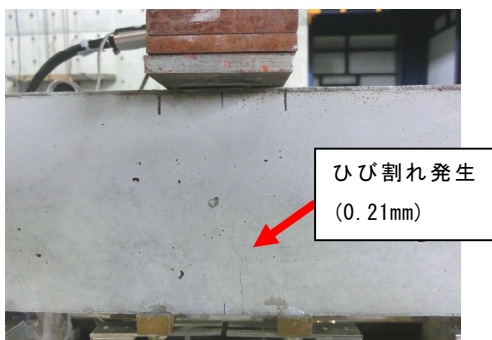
AZY2 ひび割れ発生時 (側面)
